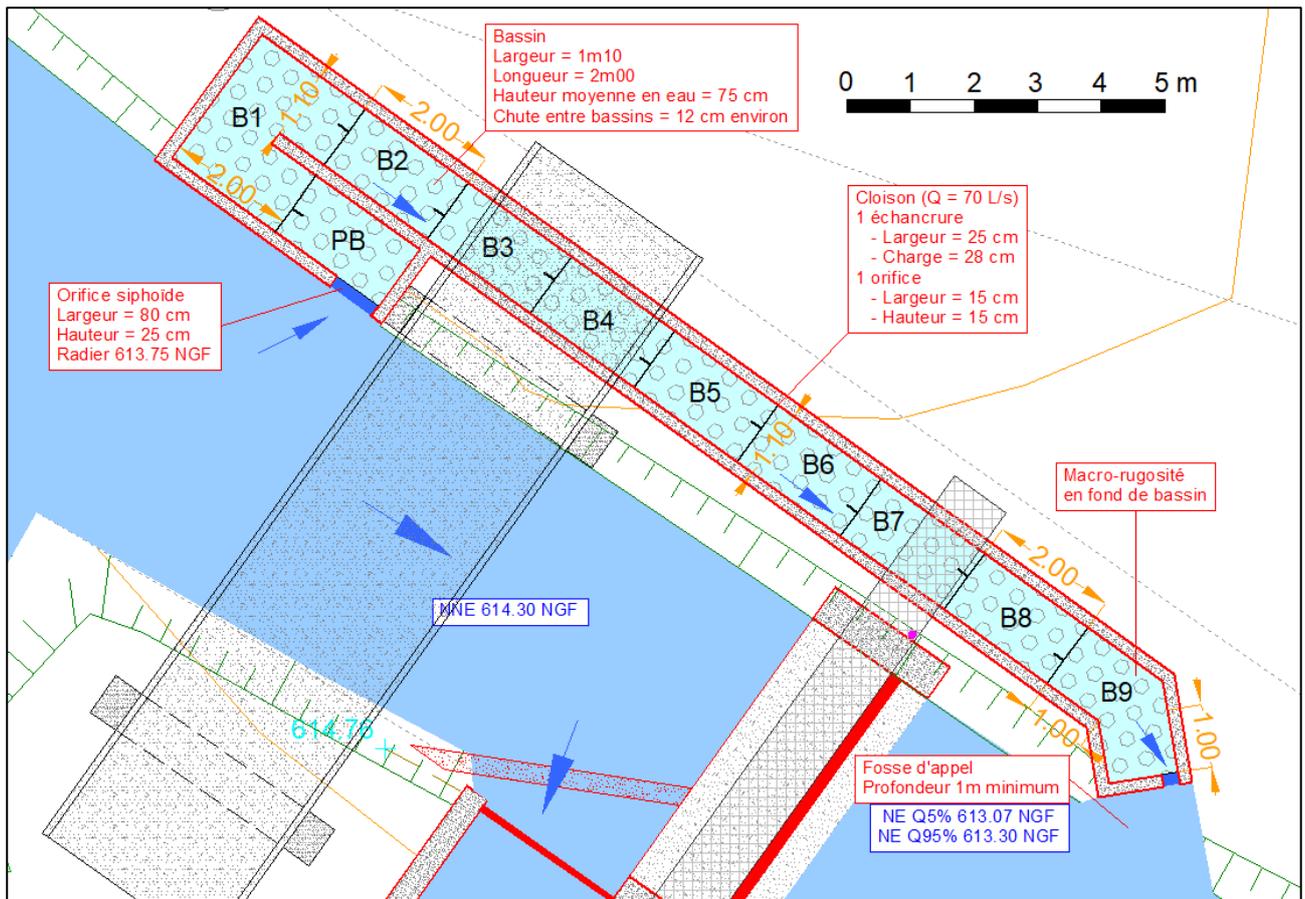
Extrait du plan d'implantation de la passe à poissons
